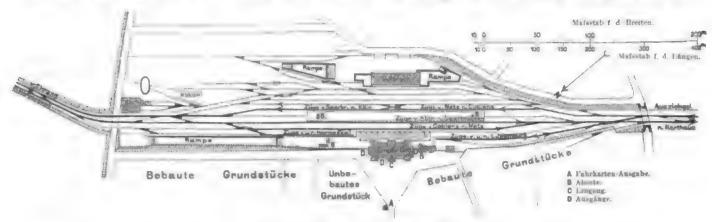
Bahnhof Trier r. M. Allgemeiner Lageplan.
